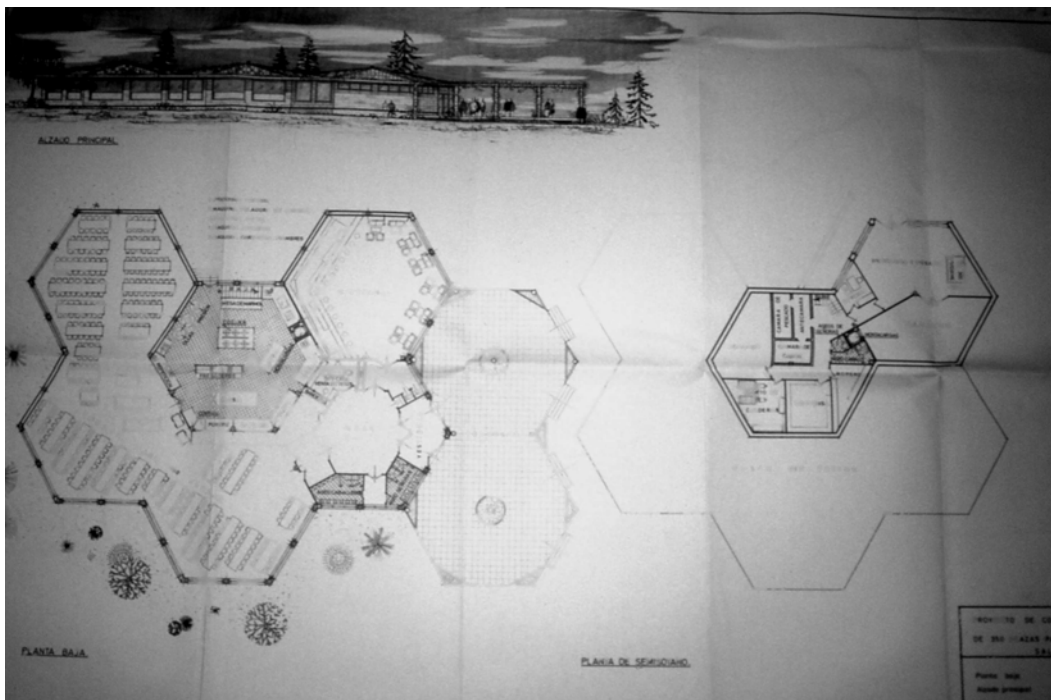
Comedor Peñuelas de San Blas: alzado principal, planta baja y sótano.
